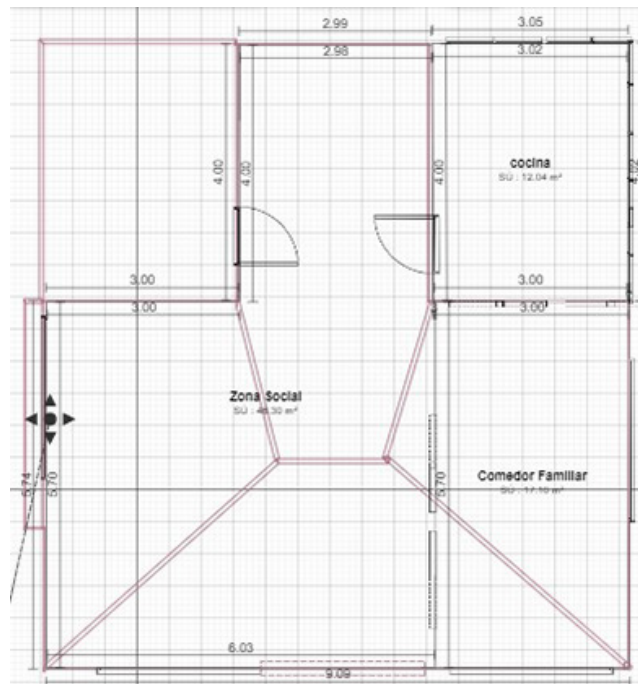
Primera planta de la vivienda familiar Escala 1:50
